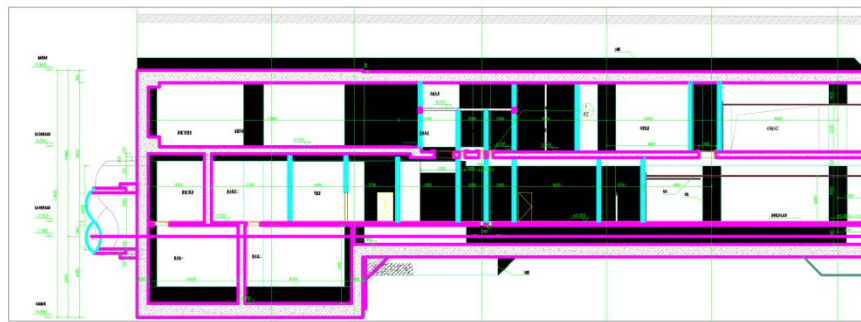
车站 1-1 剖面 1 区（1~7 轴）剖面图
